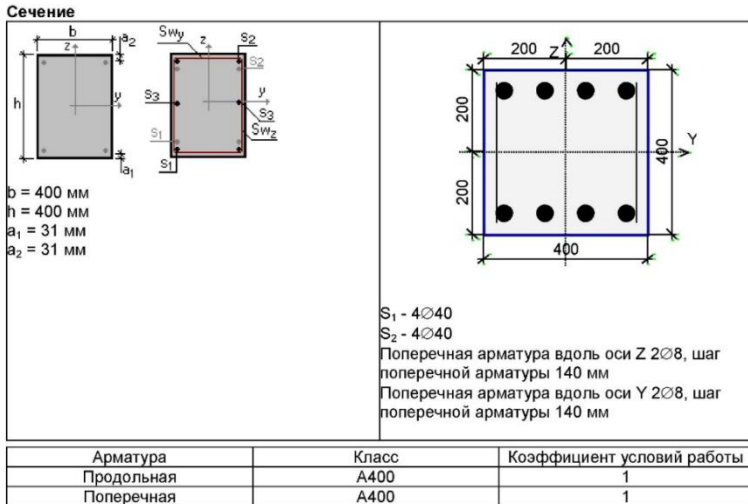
Сечение колонны и раскладка арматурных стержней.
